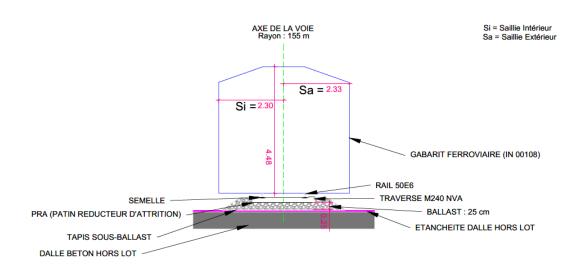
Coupe type de la voie sur ballast (source : ARTELIA)1
